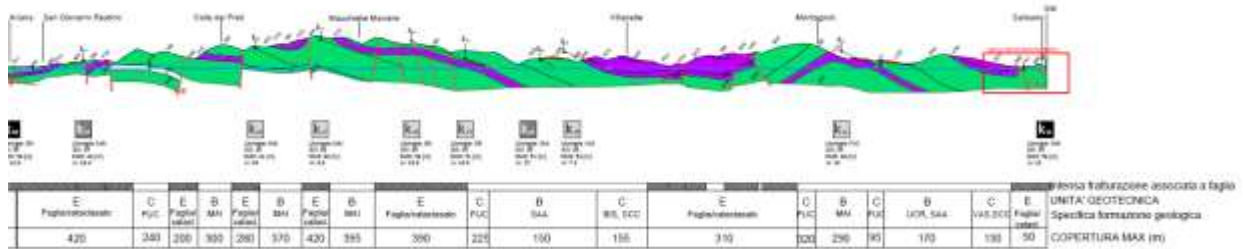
Stralcio del profilo geomeccanico della galleria Monte Vecchio.
